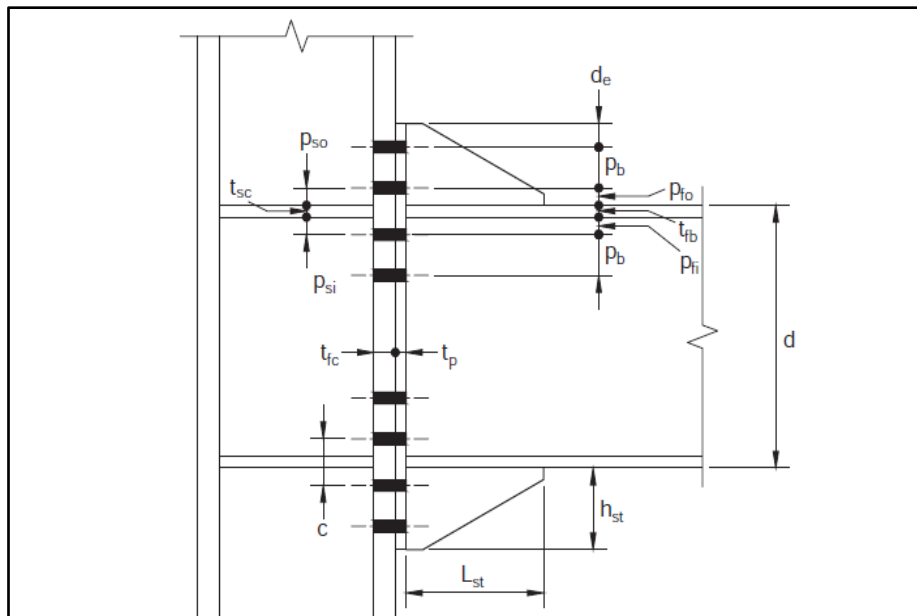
Geometría de placa de extremo extendida reforzada con ocho pernos (8ES). AISC358 (2016)
